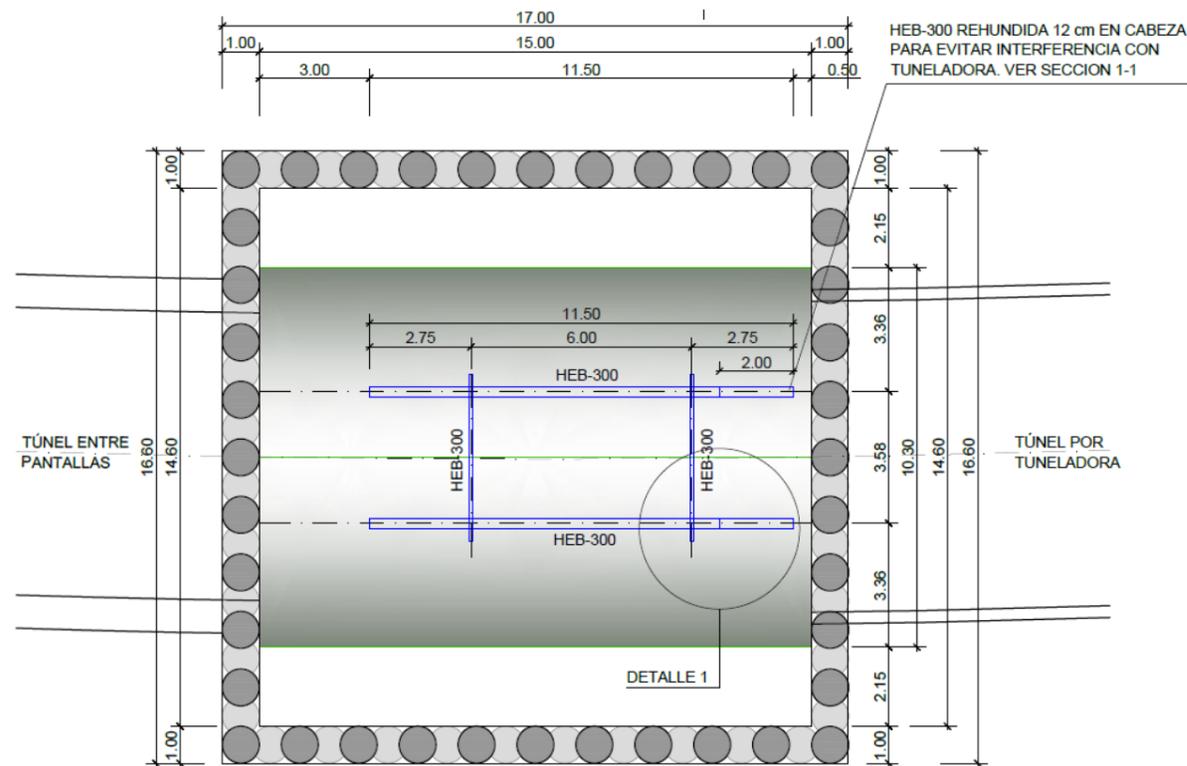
Geometría y solución estructural de los pozos de extracción de las alternativas.
